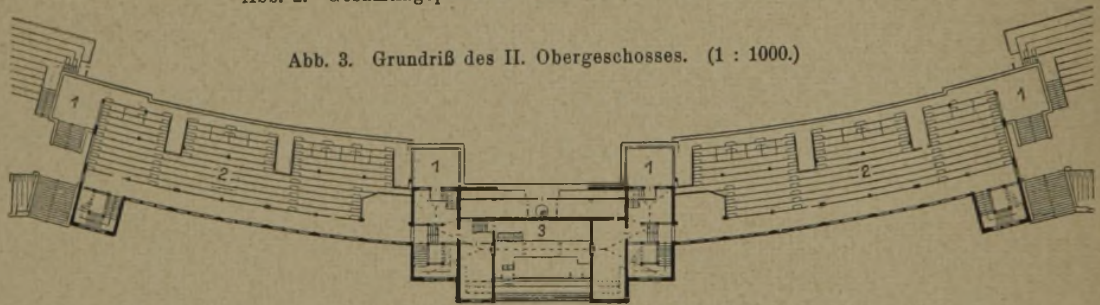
Grundriß des II. Obergeschosses. (1 : 1000.)
